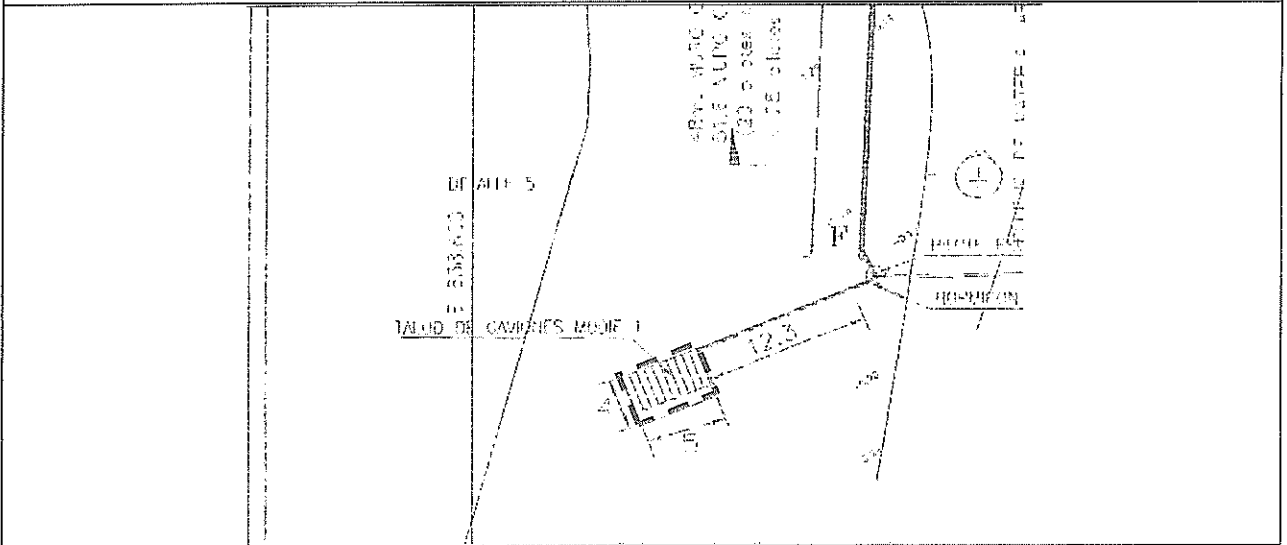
Extracto de plano de construcción N°3 de 3, posición real de talud de gaviones.
